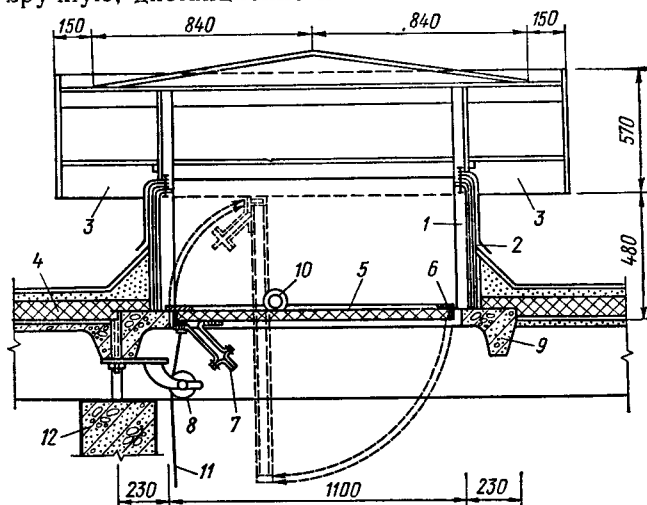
Вентиляционная дымовая шахта ДВС в бесчердачном покрытии (конструкция Госхимпроекта):
